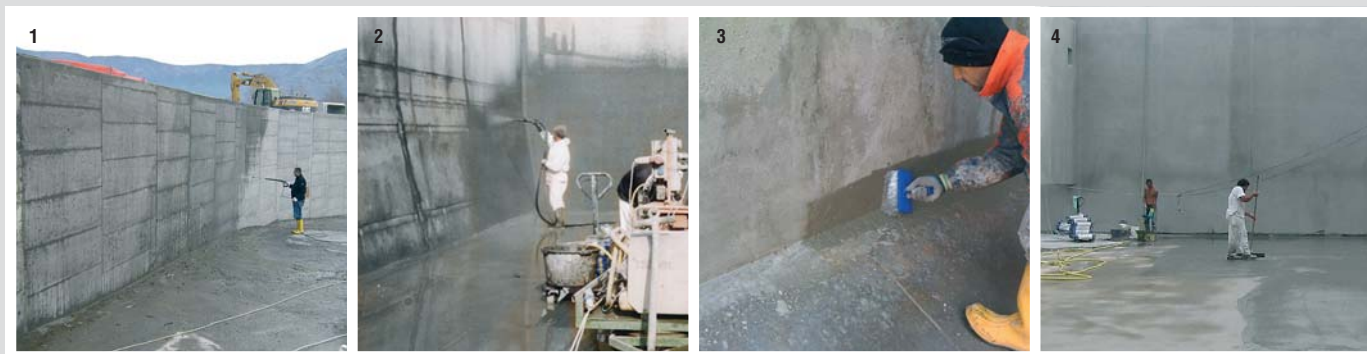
Pulizia e lavaggio del supporto - Foto 2) Applicazione a spruzzo - Foto 3) Applicazione a pennello - Foto 4) Applicazione a spazzolone
